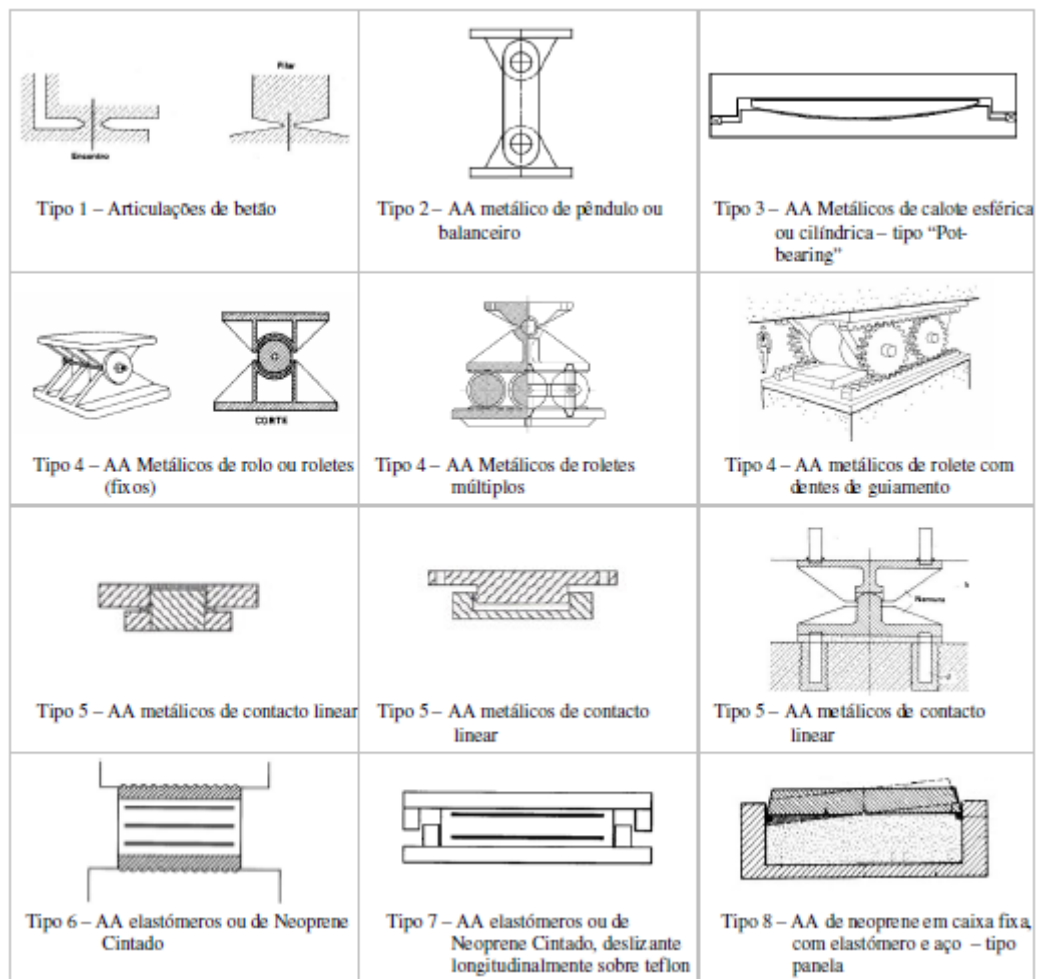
Tipos de aparelho de apoio (Marques & Cunha, 1999).
